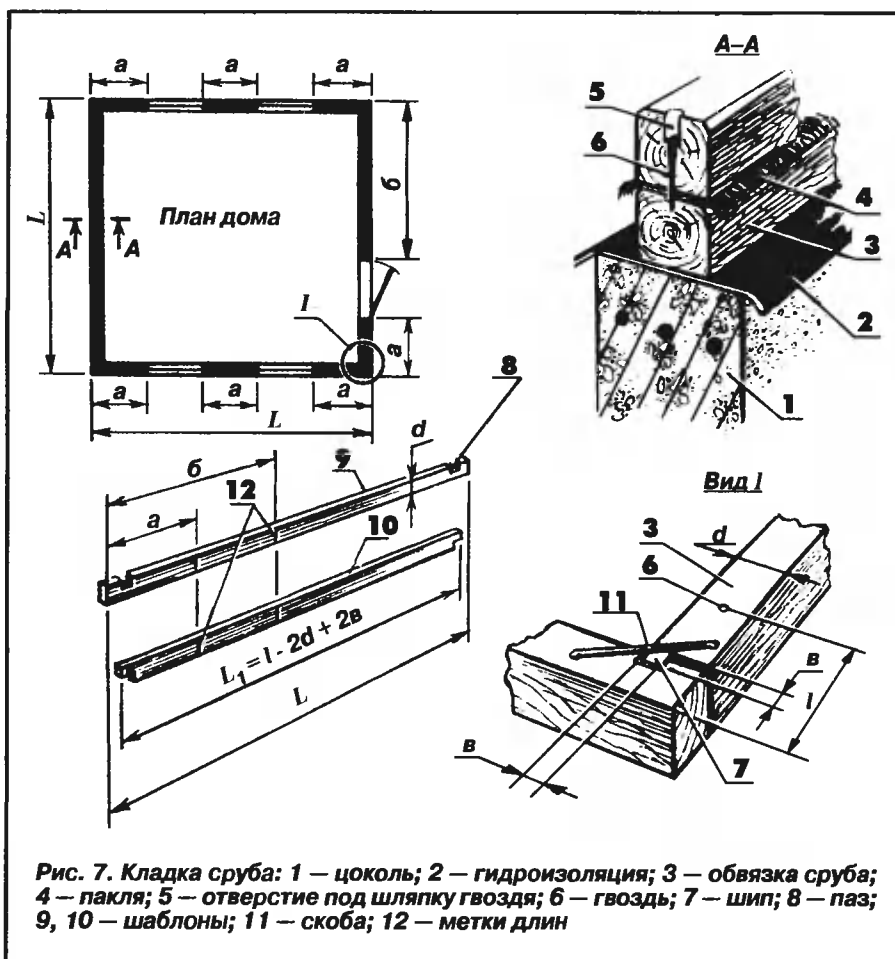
Кладка сруба: 1 — цоколь; 2 — гидроизоляция; 3 — обвязка сруба; 4 — пакля; 5 — отверстие под шляпку гвоздя; 6 — гвоздь; 7 — шип; 8 — паз; 9, 10 — шаблоны; 11 — скоба; 12 — метки длин
